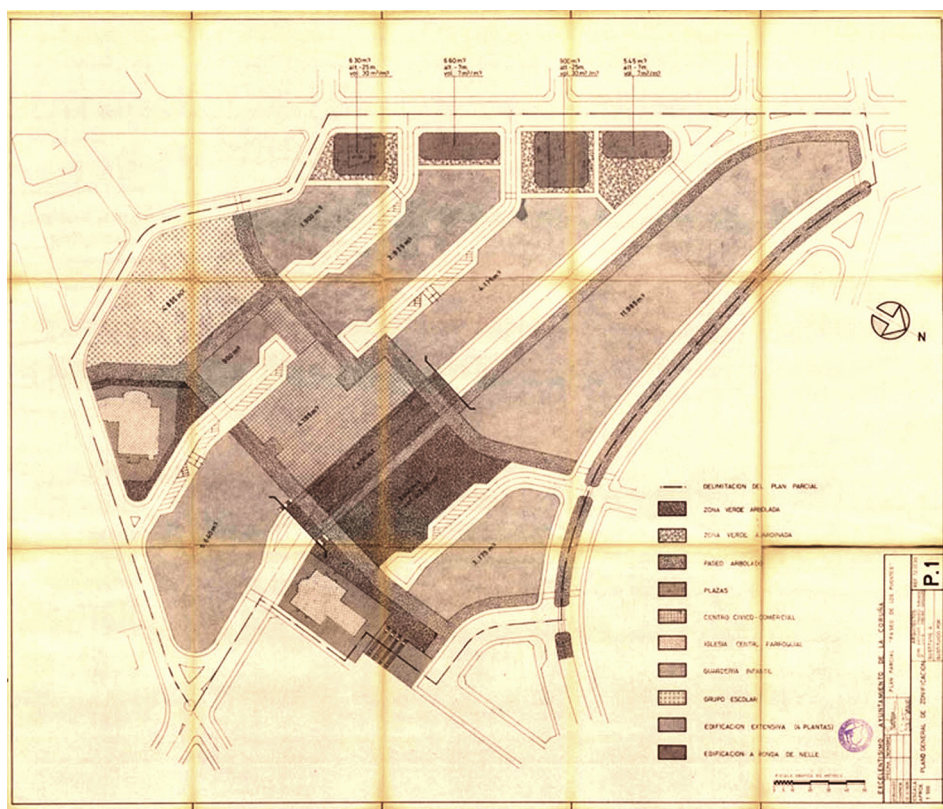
Plano General Plan Parcial Paseo Puentes. Fuente: Archivo Personal de José Antonio Franco Taboada.
